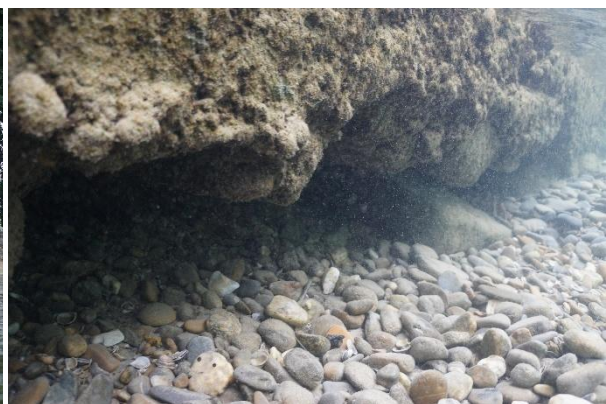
Uferbau mit Beton und Blöcken, teilweise unterspült bei Transekt A.
